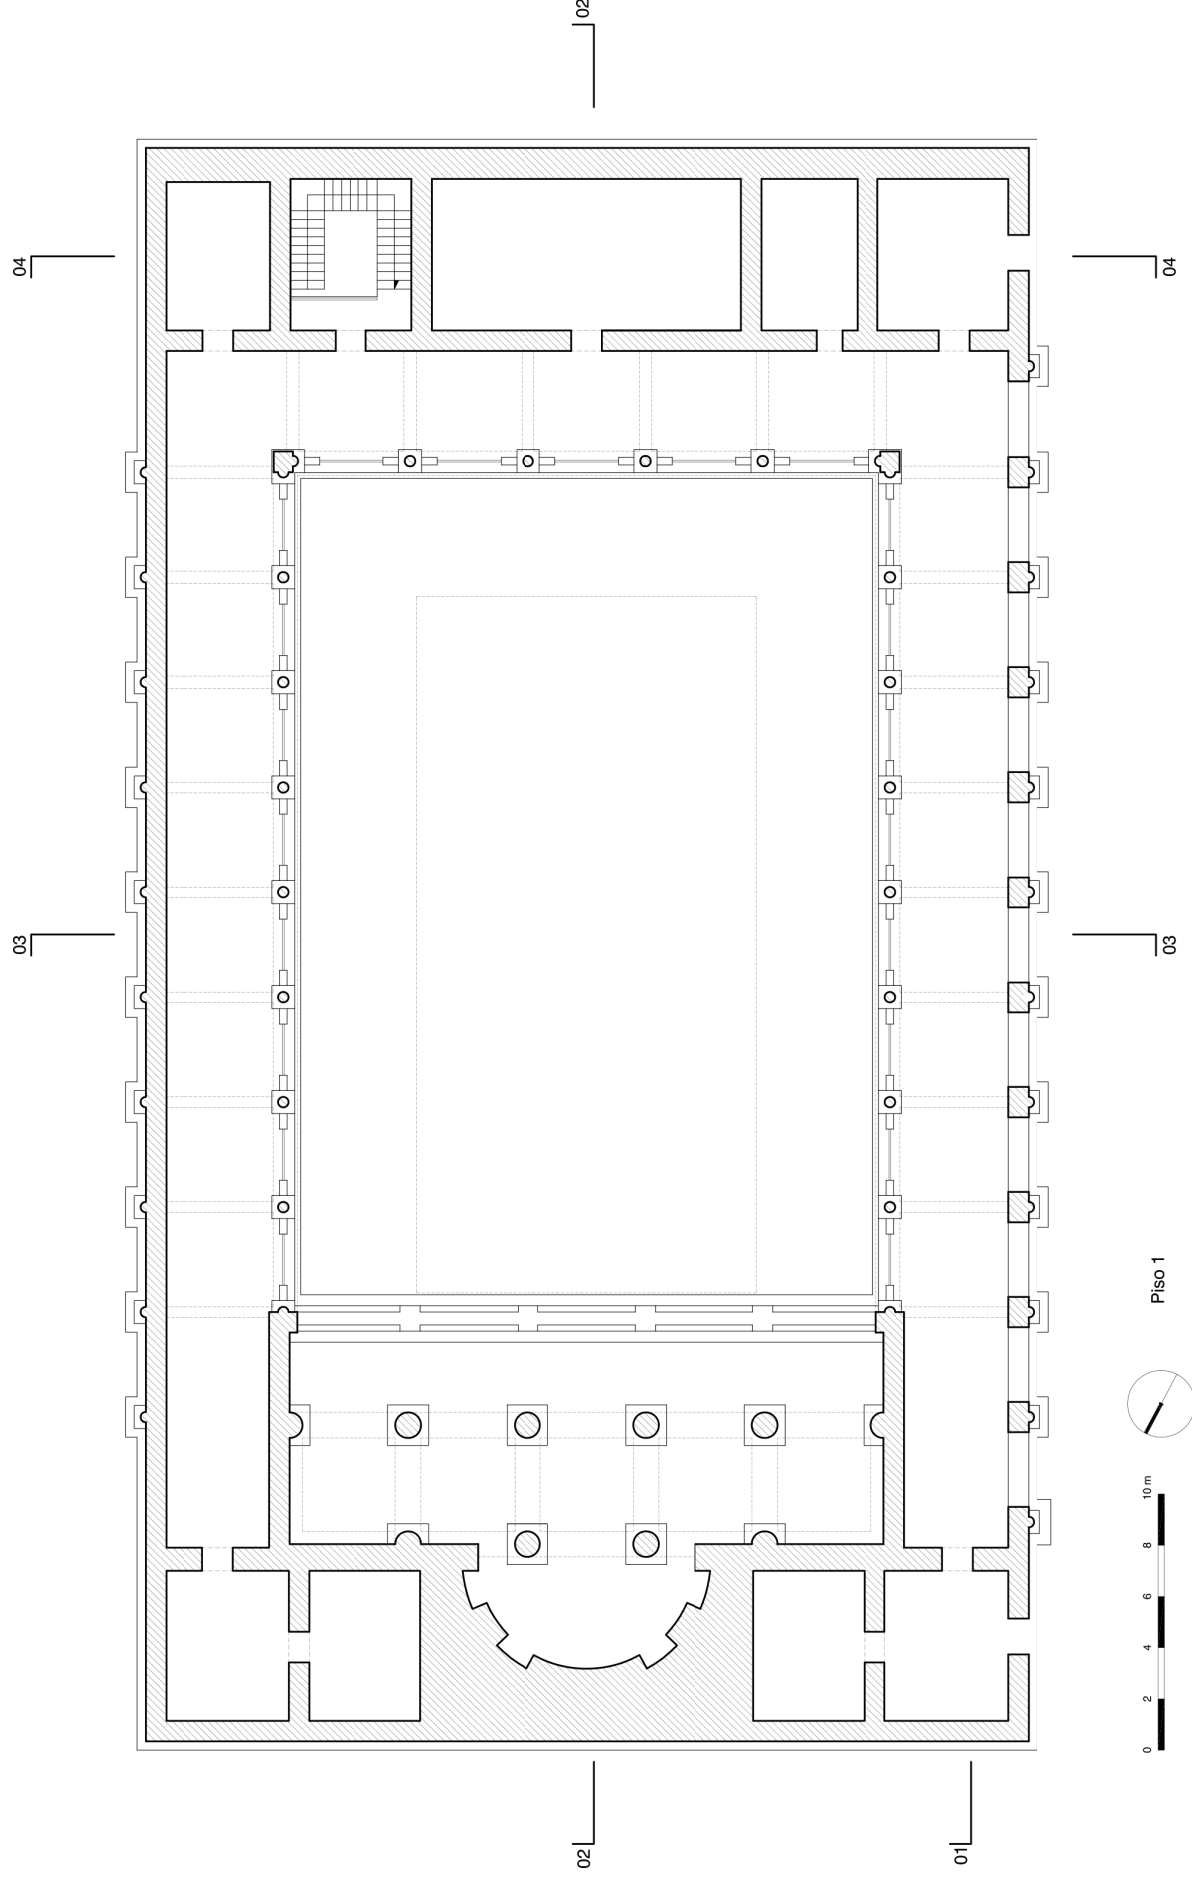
Planta do piso 1 do fórum claudiano (desenho de Paulo Barreiras).
